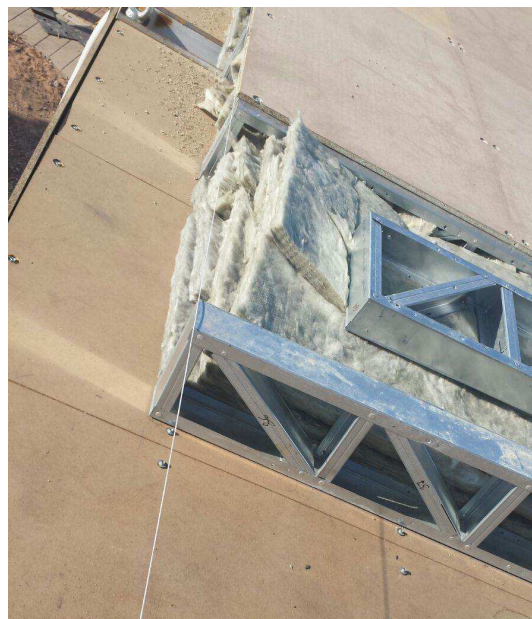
Colocación del aislamiento entre cerchas / [EBH16]
